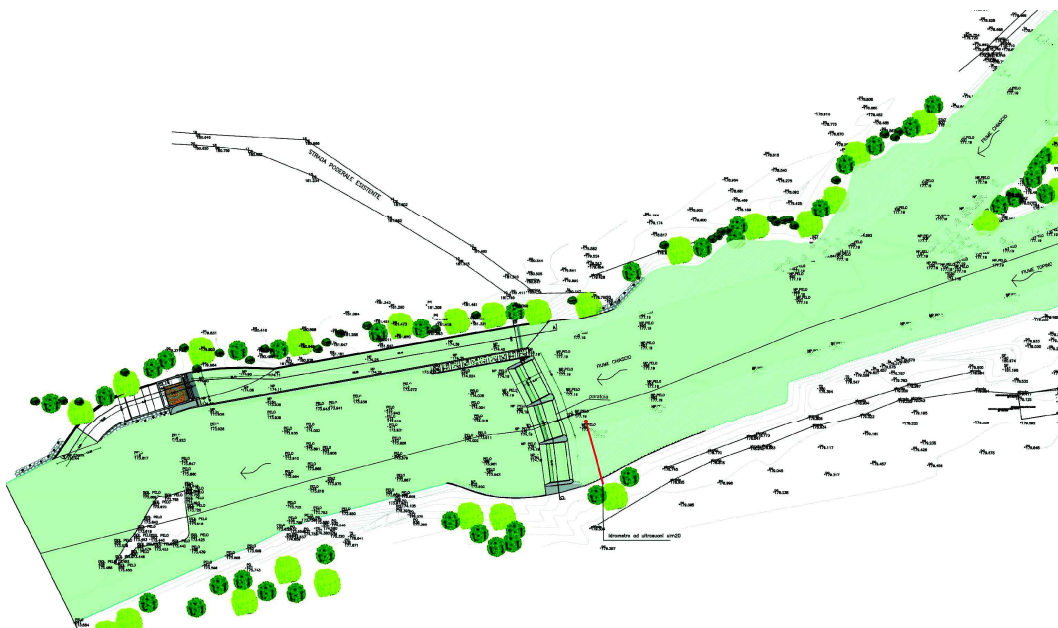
planimetria generale della Centrale di Passaggio di Bettona sul fiume Chiascio a Bettona (PG)
